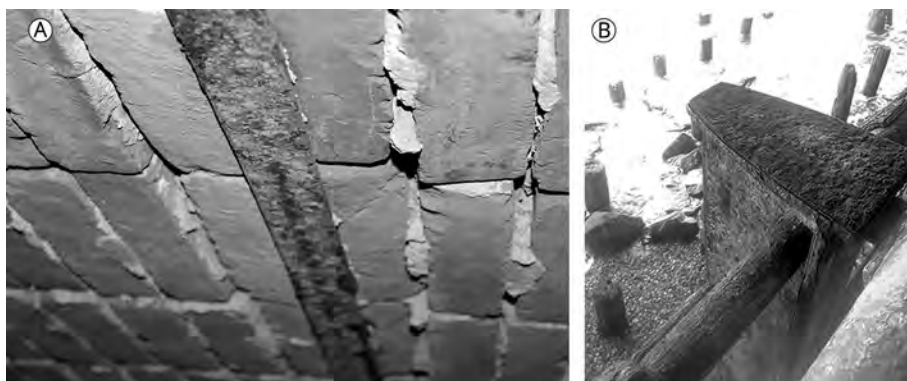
Corrosão uniforme em (A) viga metálica de casa histórica e (B) guarda-corpo
